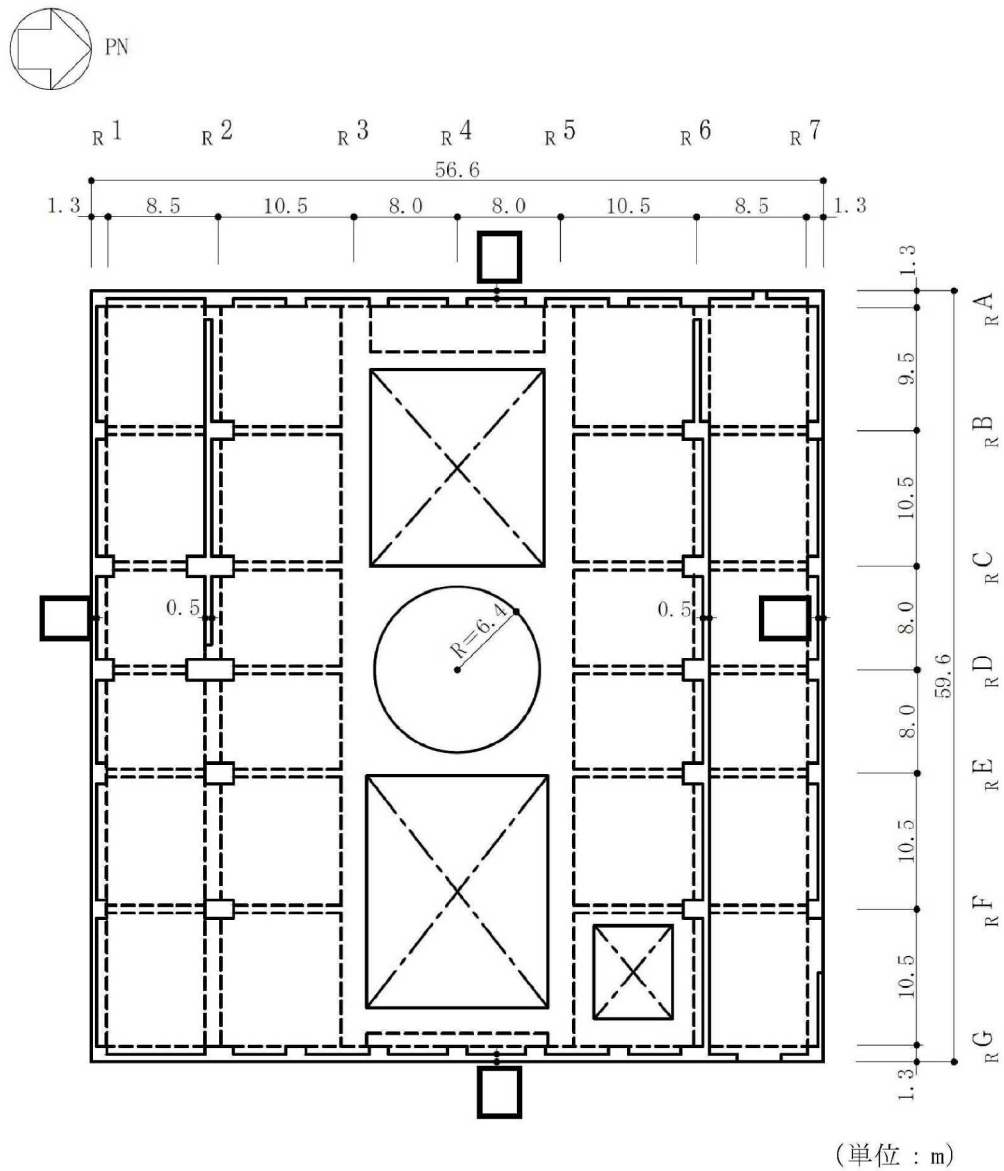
原子炉建屋の概略平面図 (4F, T.M.S.L. 31.7m) (7/9)
